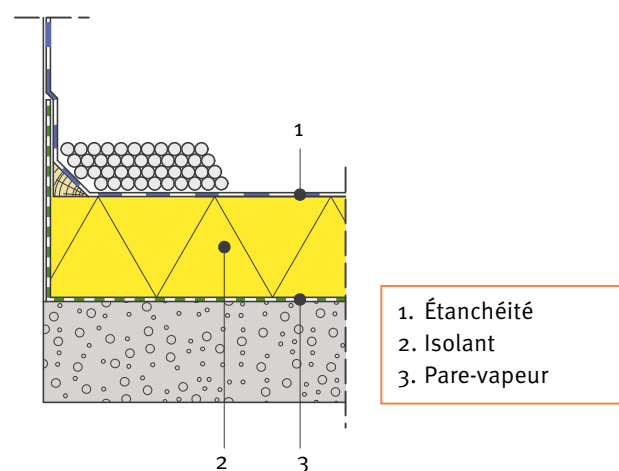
Raccordement du pare-vapeur et de l'étanchéité.
